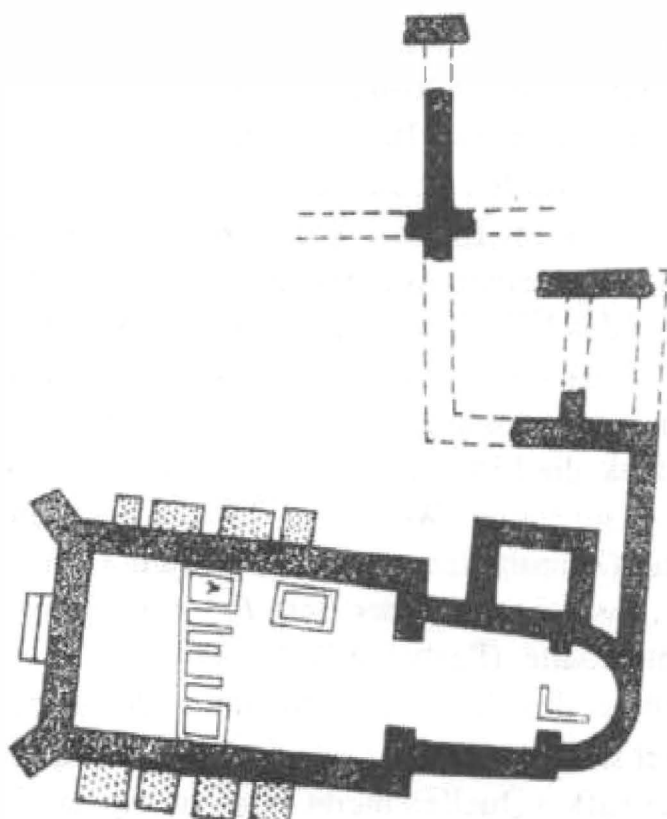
A. Cusici Klosteranlage, Grundriss ;
